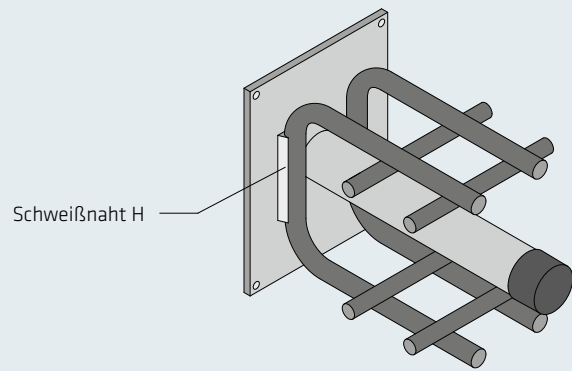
Schweißnähte H für DB-N und DB-Q Hülzen
